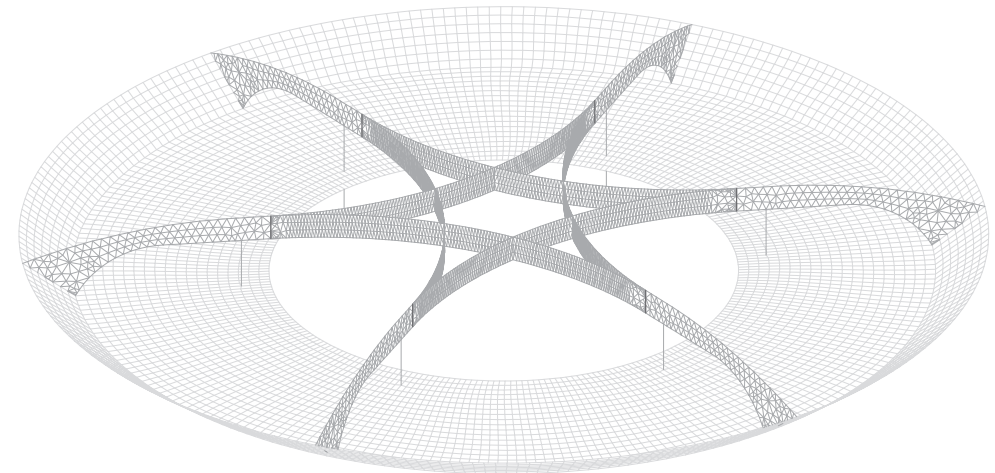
Modelización de las vigas superiores en elementos finitos. Unión con los pilares y con el forjado que sustenta
